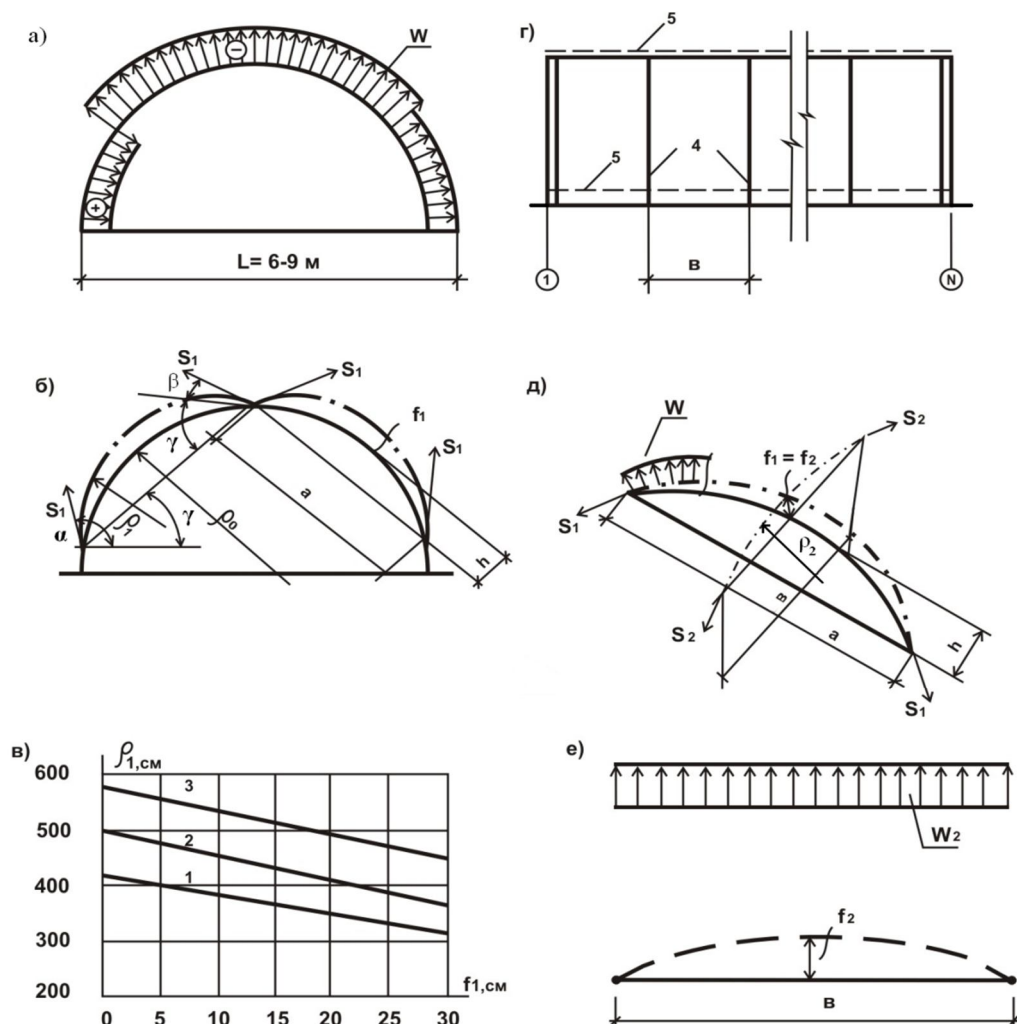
К статическому расчету мягкой кровли сооружения: а – схема ветровой нагрузки на сооружение; б – схема сооружения с деформированной кровлей; в – графики изменения радиуса кривизны кровли; г – схема расположения ветровых канатов по длине сооружения; д – схема совместности деформаций в рассчитываемых нитях; е – расчетная схема нити между ветровыми канатами; 1 – пролет сооружения 6 м; 2 – пролет 7,5 м; 3 – пролет 9 м; 4 – ветровой канат; 5 – элементы крепления кровли в коньке и цоколе сооружения
